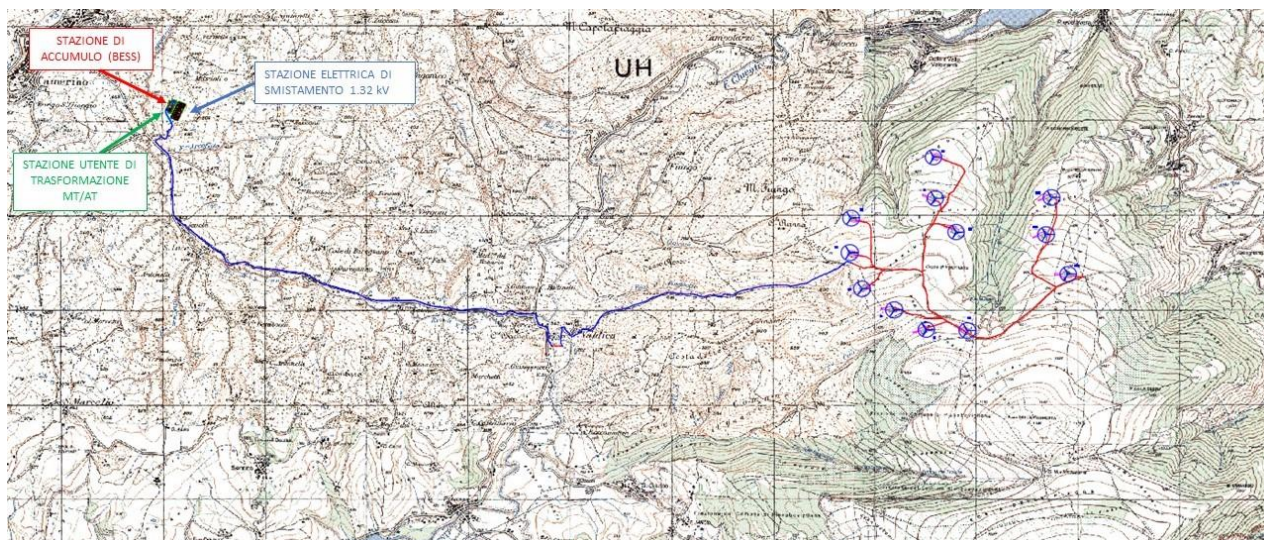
Stralcio di cartografia IGM della zona con ubicazione dell'area d'impianto e delle opere accessorie per il collegamento alla rete elettrica nazionale.
